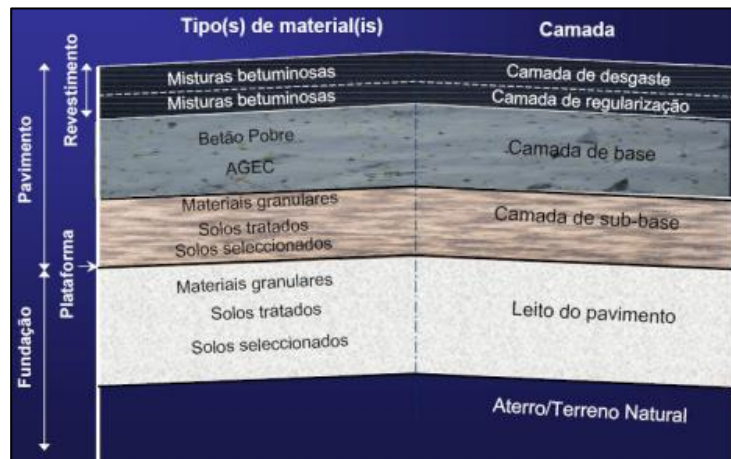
Estrutura de um pavimento semirrígido (Reis, op. cit.)
